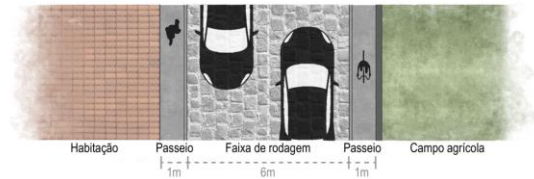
Planta proposta das Rua da Praia e Rua Cimo de Vila
